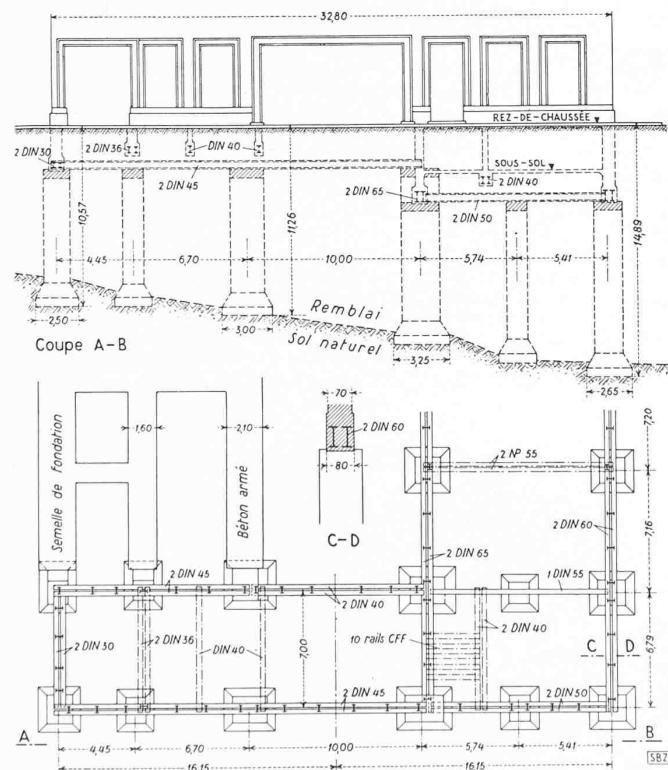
Fondation du Bâtiment principal, côté Ouest. — 1:400
